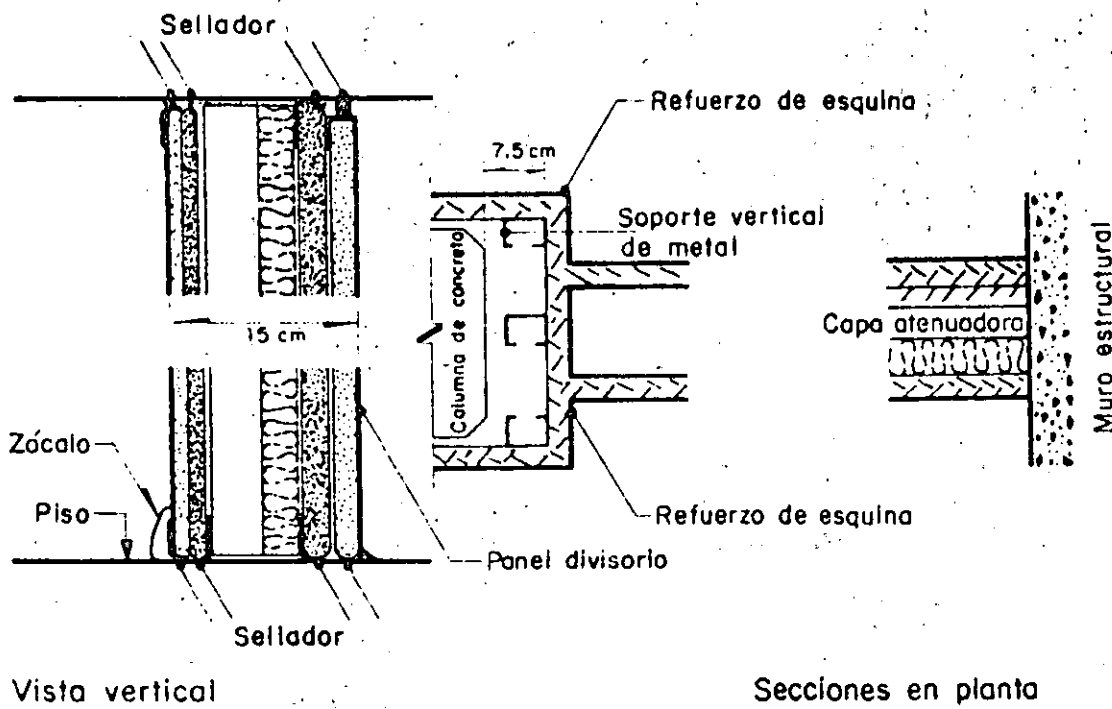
Detalles para desligar muros divisorios de la estructura (ref 72)
